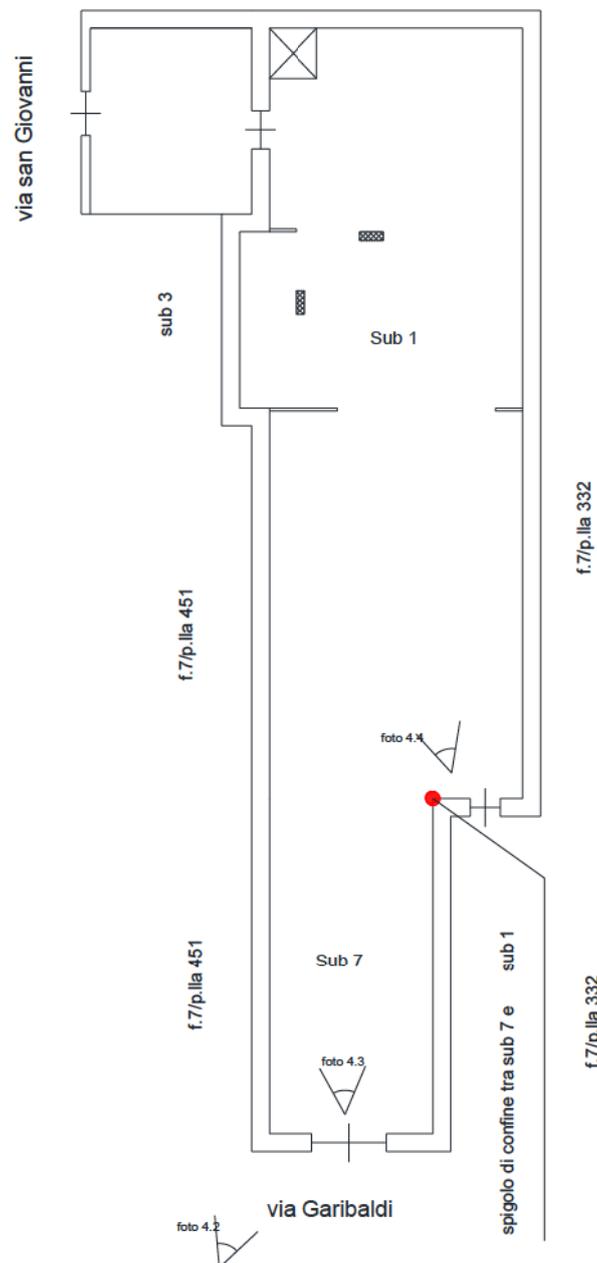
Planimetria del subalterno 7 e 1 oggetto di pignoramento
